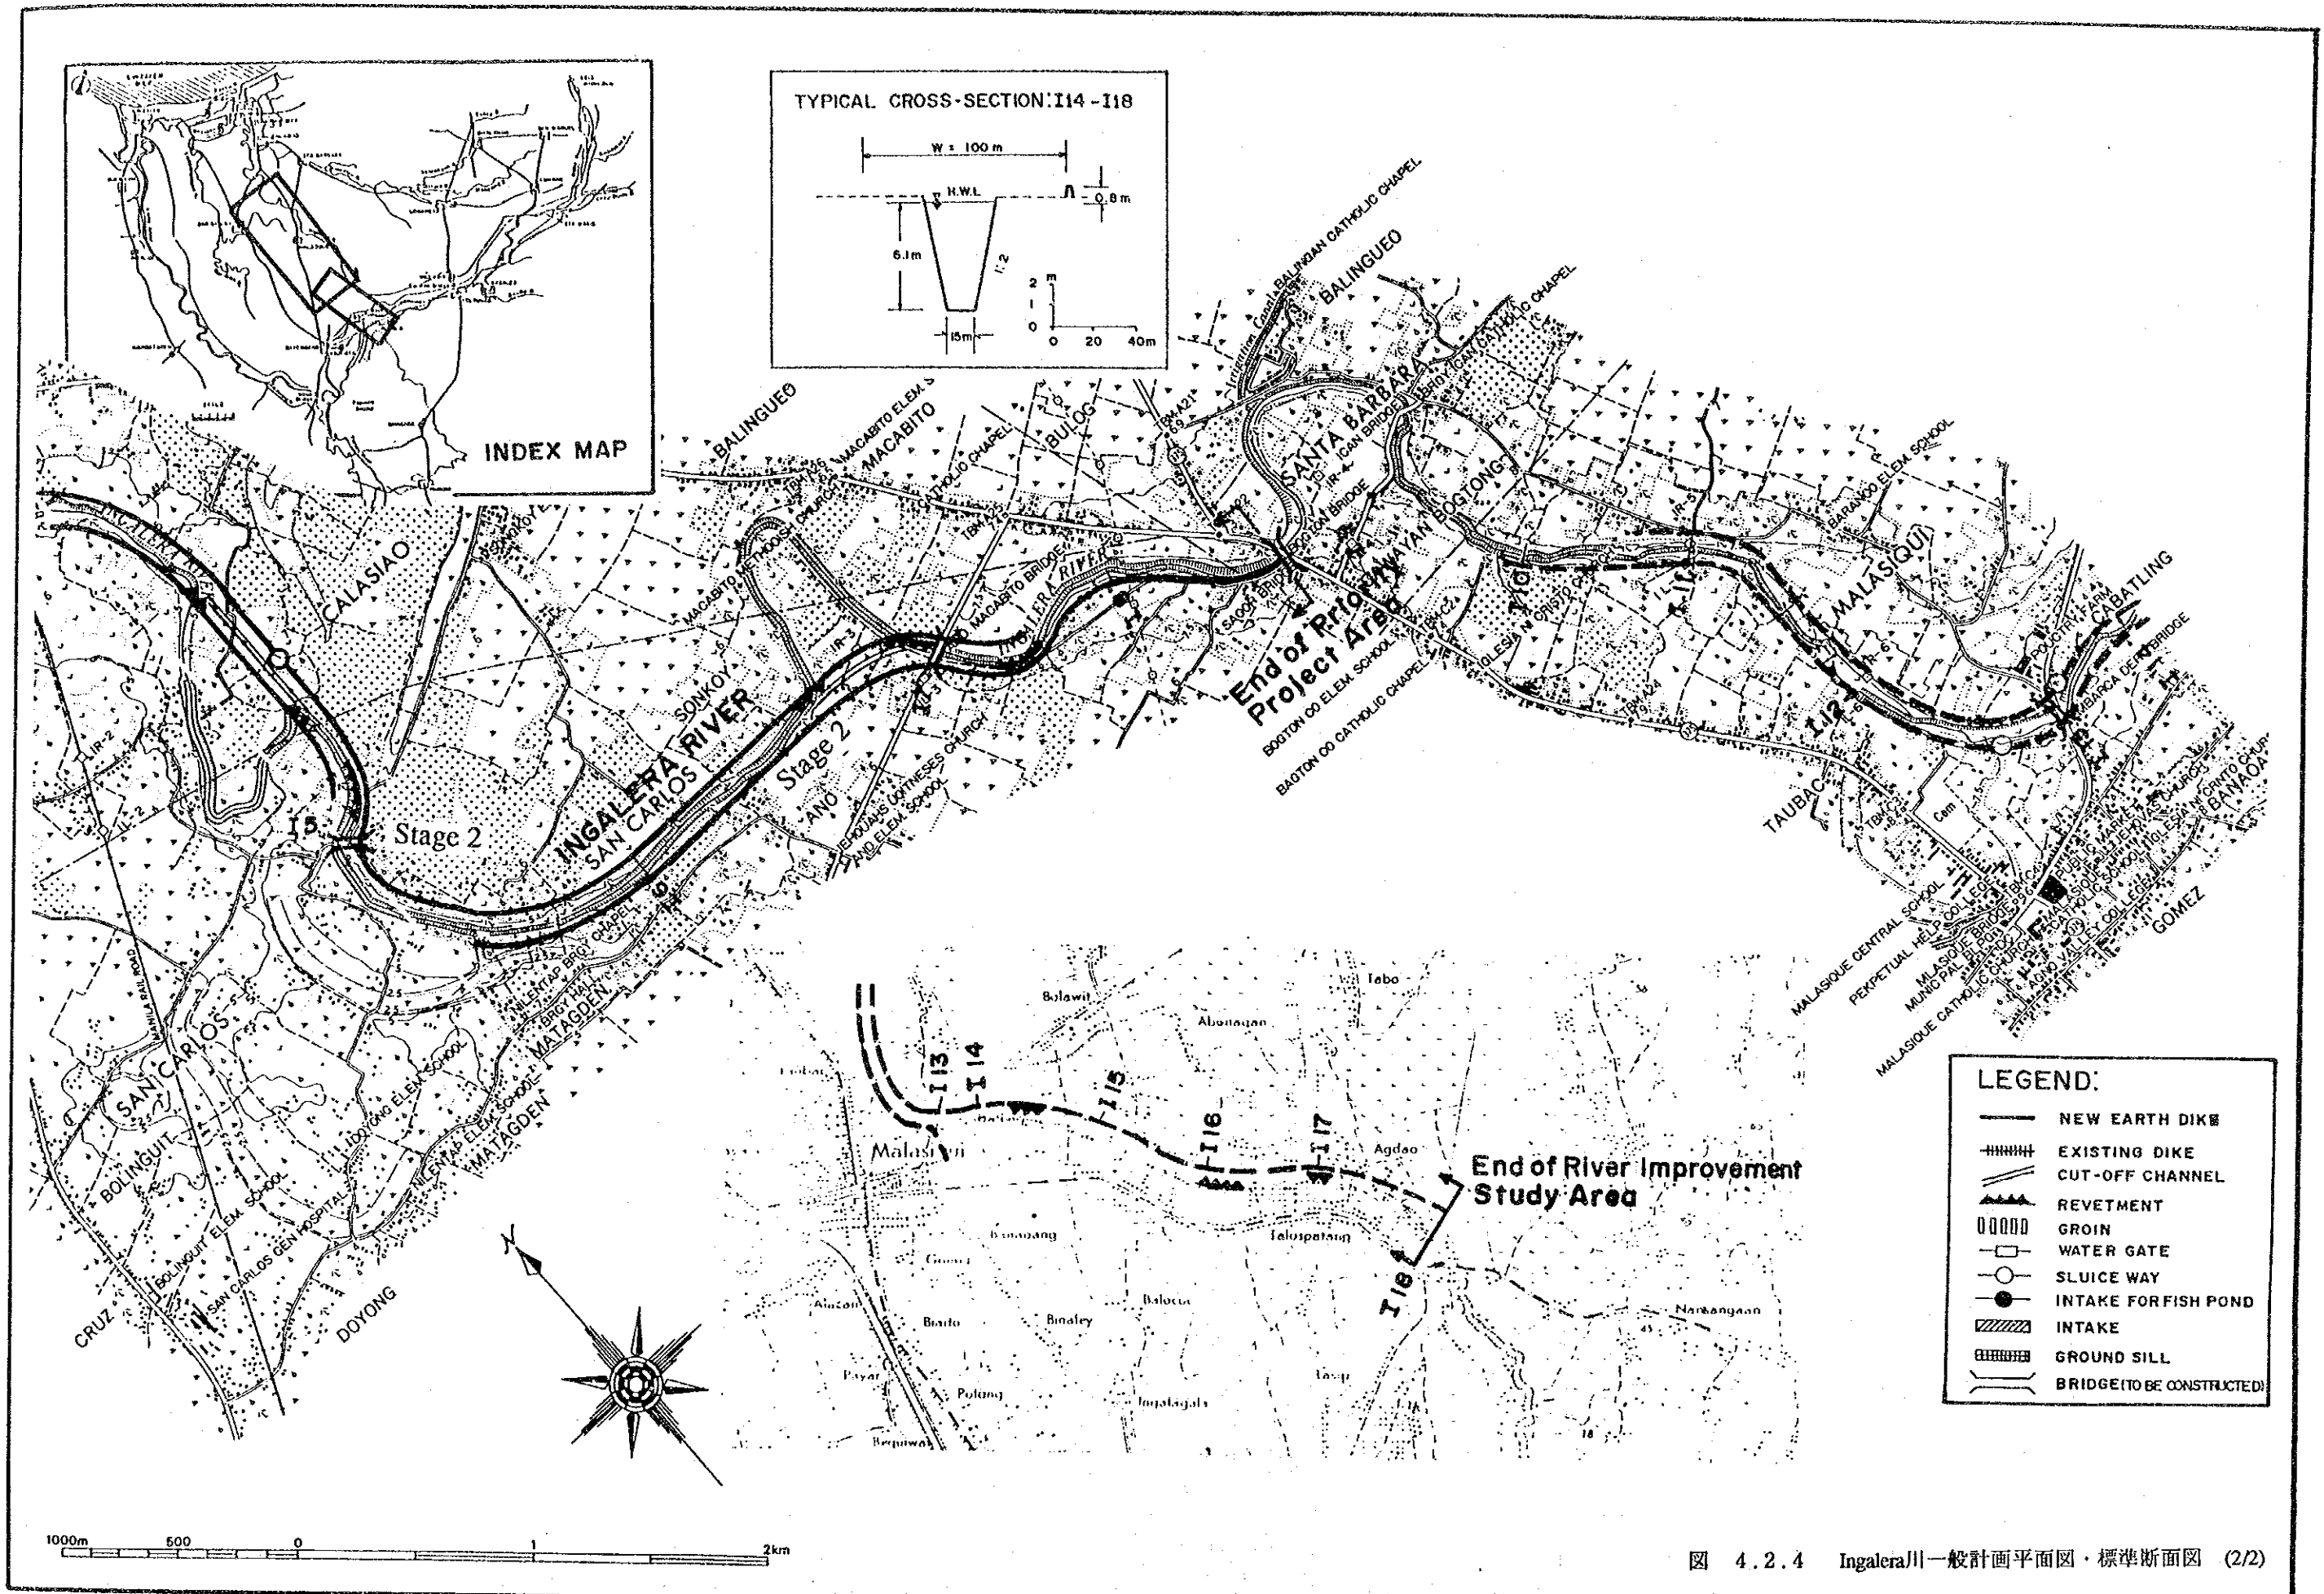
Ingalera川一般計画平面図・標準断面図 (1/2)
